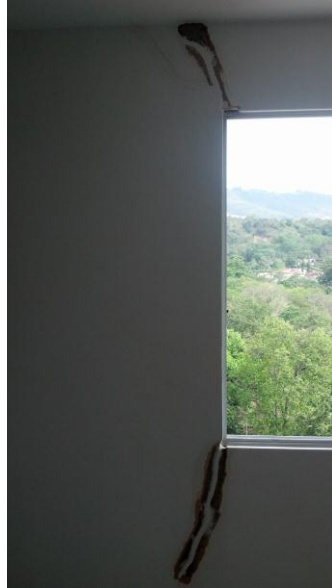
Antepecho en concreto fisurado en la esquina inferior derecha de la ventana parte interna de la alcoba.
